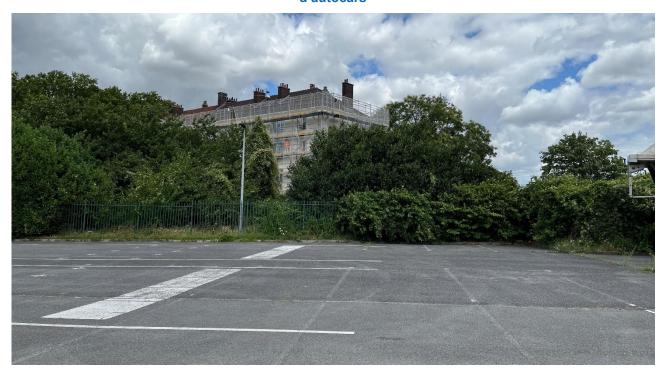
Vue sur le parking d'autocars depuis le sud-est du site d'étude
